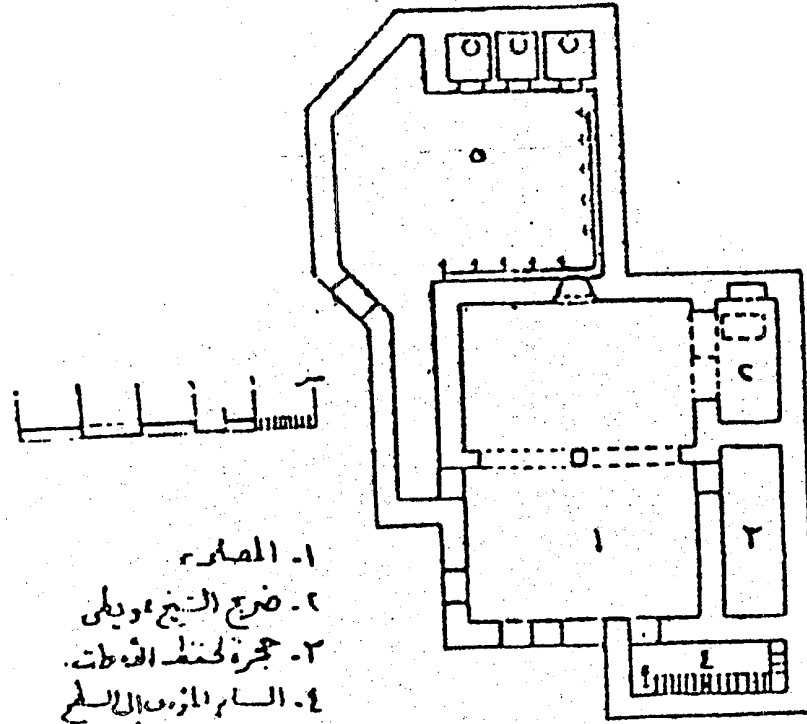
مسقط أفقي لمسجد اورخان غازي في بيلاجك (عن ، Goodwin)
